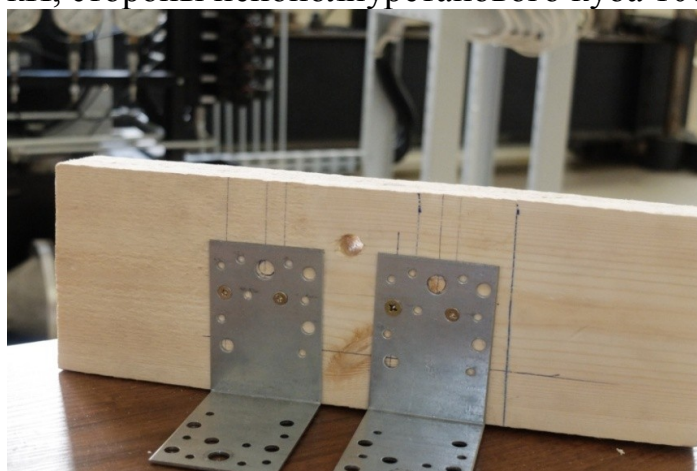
Конструкция узла для испытаний дюбеля на срез
